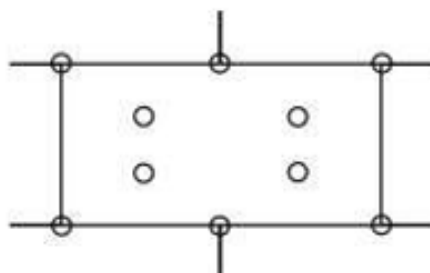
Plans de chevillage en plein et en joint en pose horizontale
